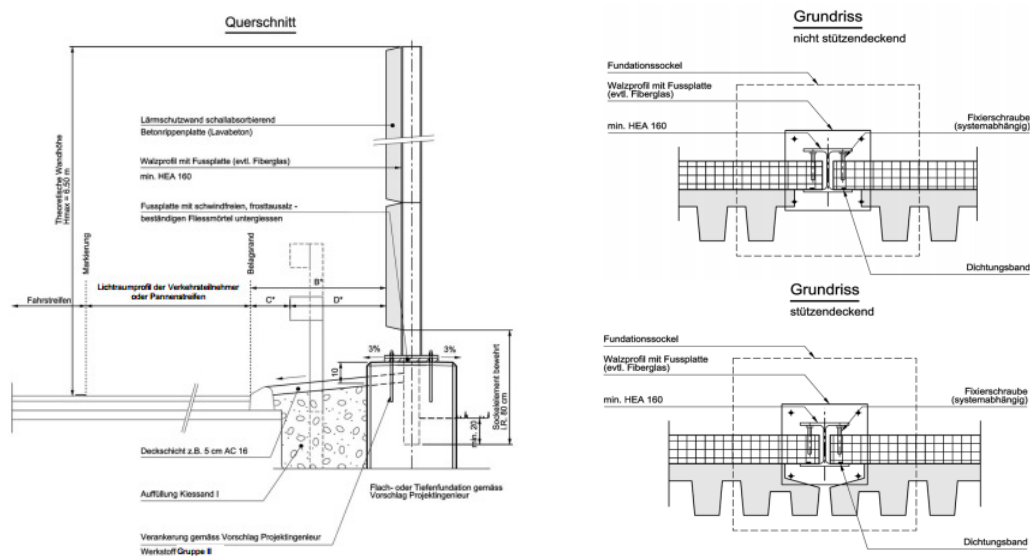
Querschnitt und Grundrisse einer Lärmschutzwand aus haufporigem Leichtbeton (ASTRA 2017)
